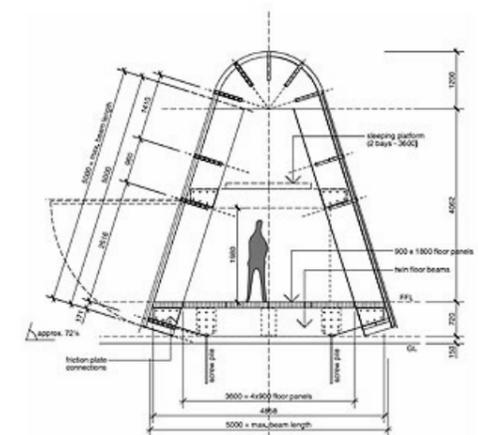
SEZIONE DELLA CARDBOARD HOUSE
